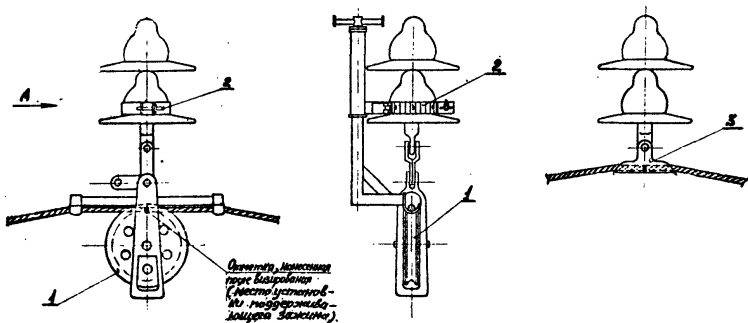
Узел А. Перекладка провода из раскаточного ролика в поддерживающий зажим
